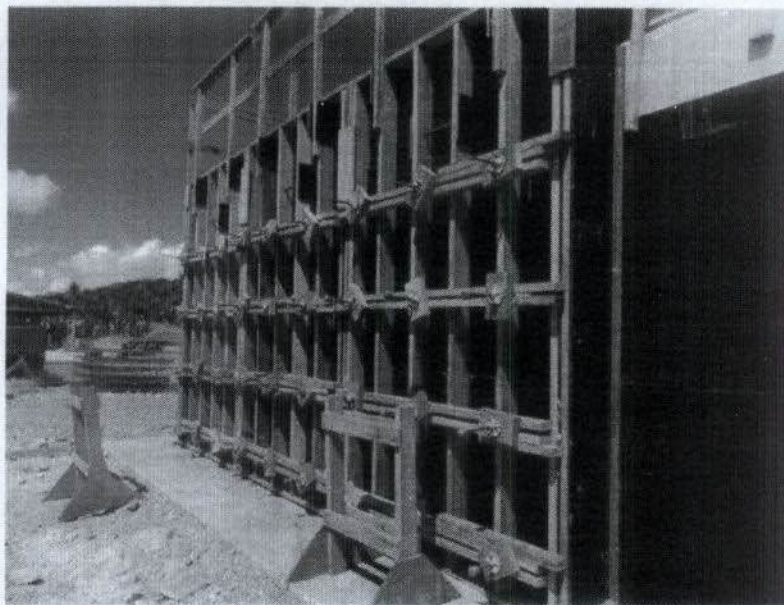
Estruturas de apoio para caixarias de formas de concreto.
